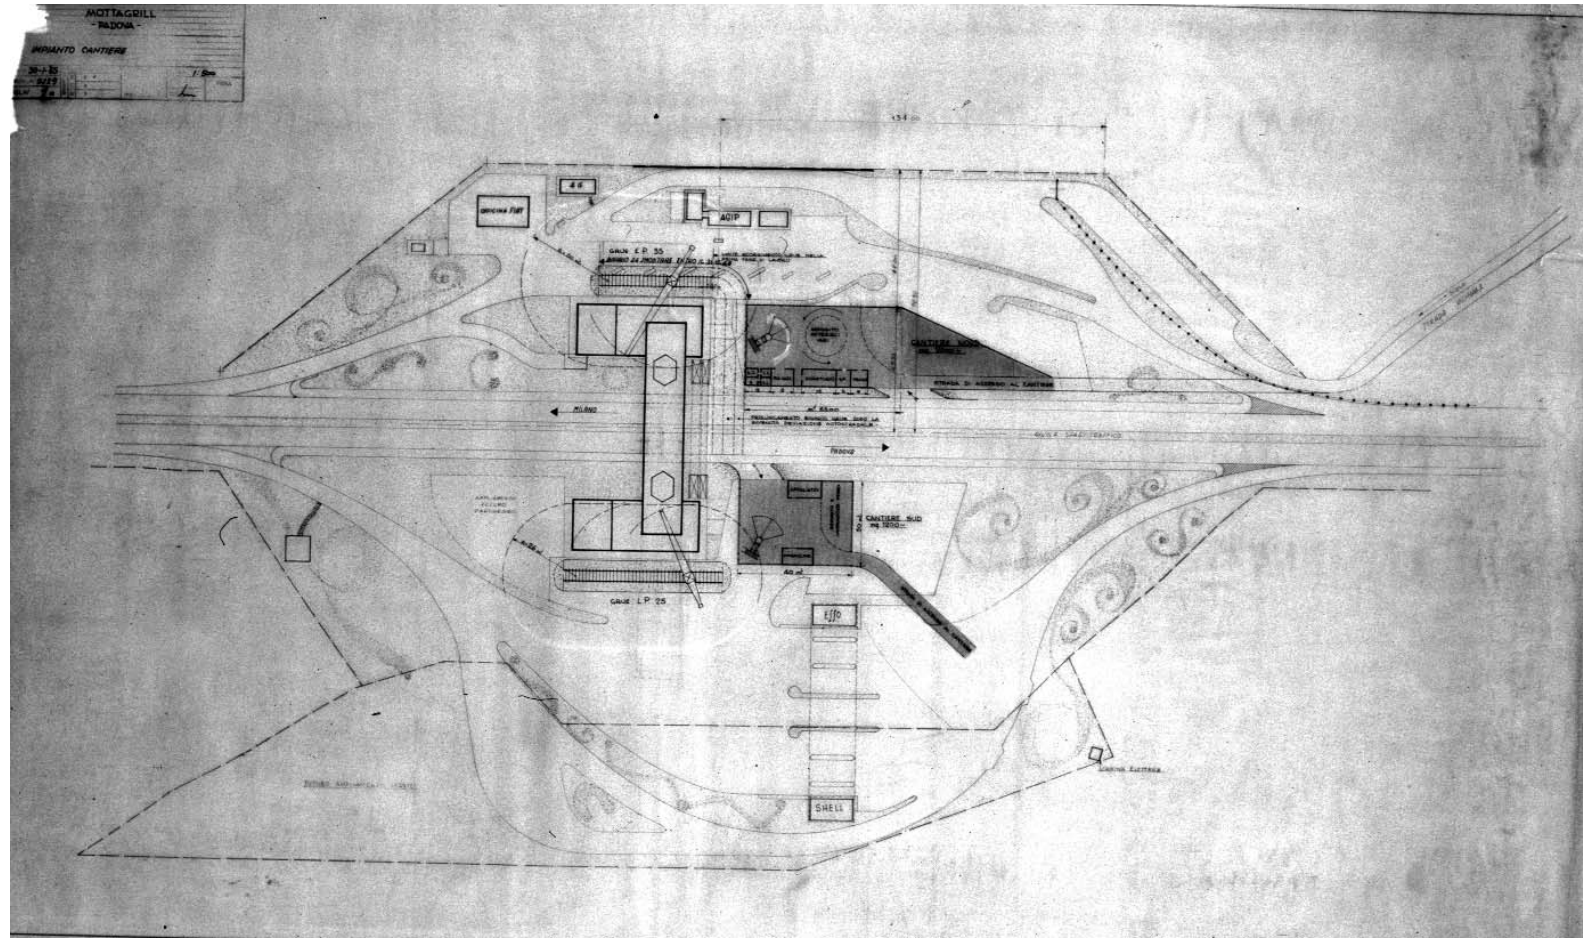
Planimetria dell'area di Limena, ((Archivio Nervi - CSAC). In evidenza la sistemazione dell'area durante il cantiere.
